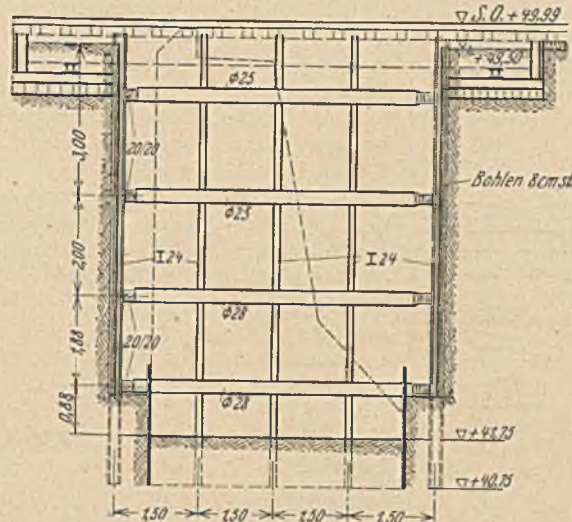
Schnitt a-a durch das westliche Widerlager mit Baugrubenaussteifung.
